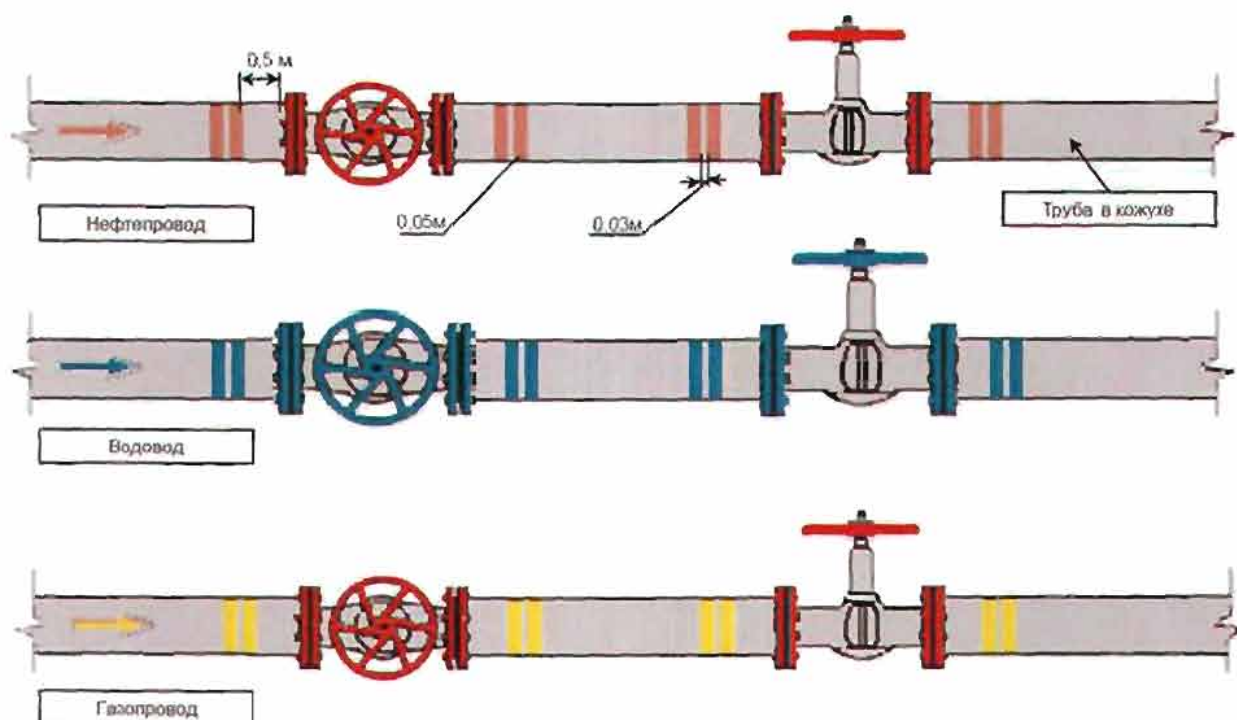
Оформление внутриплощадочных трубопроводов без теплоизоляции
